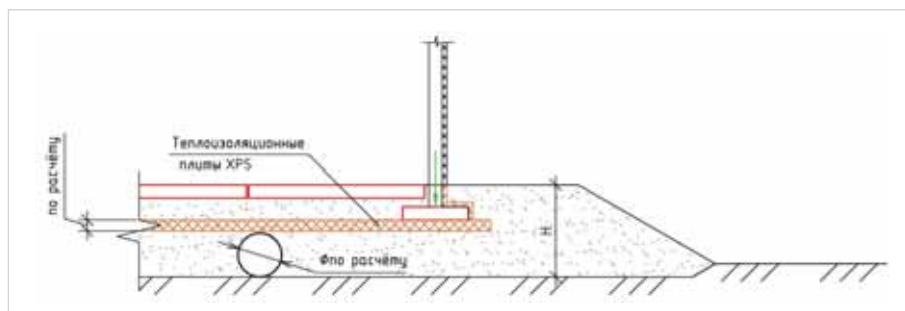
Схема устройства теплозащитного экрана из экструзионного пенополистирола в основании фундамента на отсыпке с устройством вентилируемых труб
